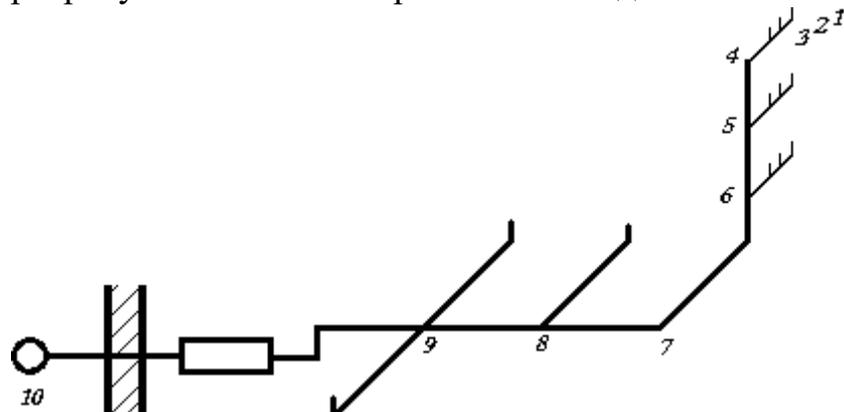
Схеми систем внутрішніх водопроводів:
